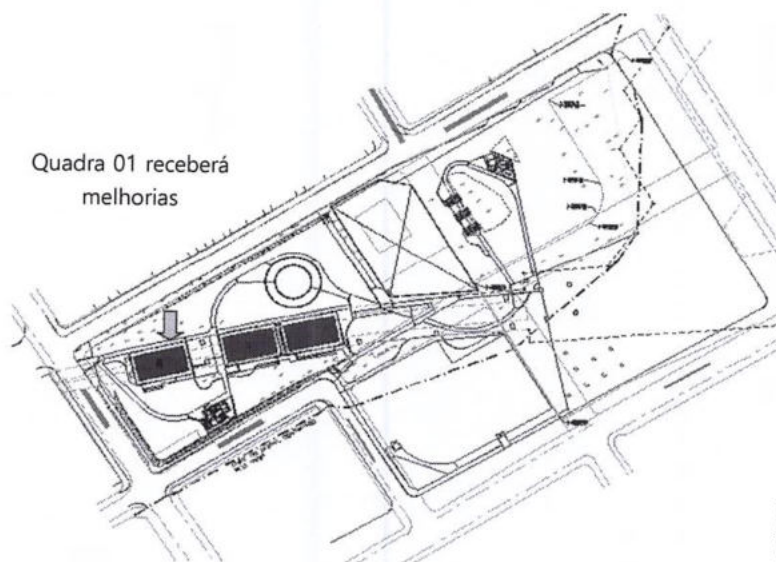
Planta de Localização da quadra que sofrerá a intervenção
